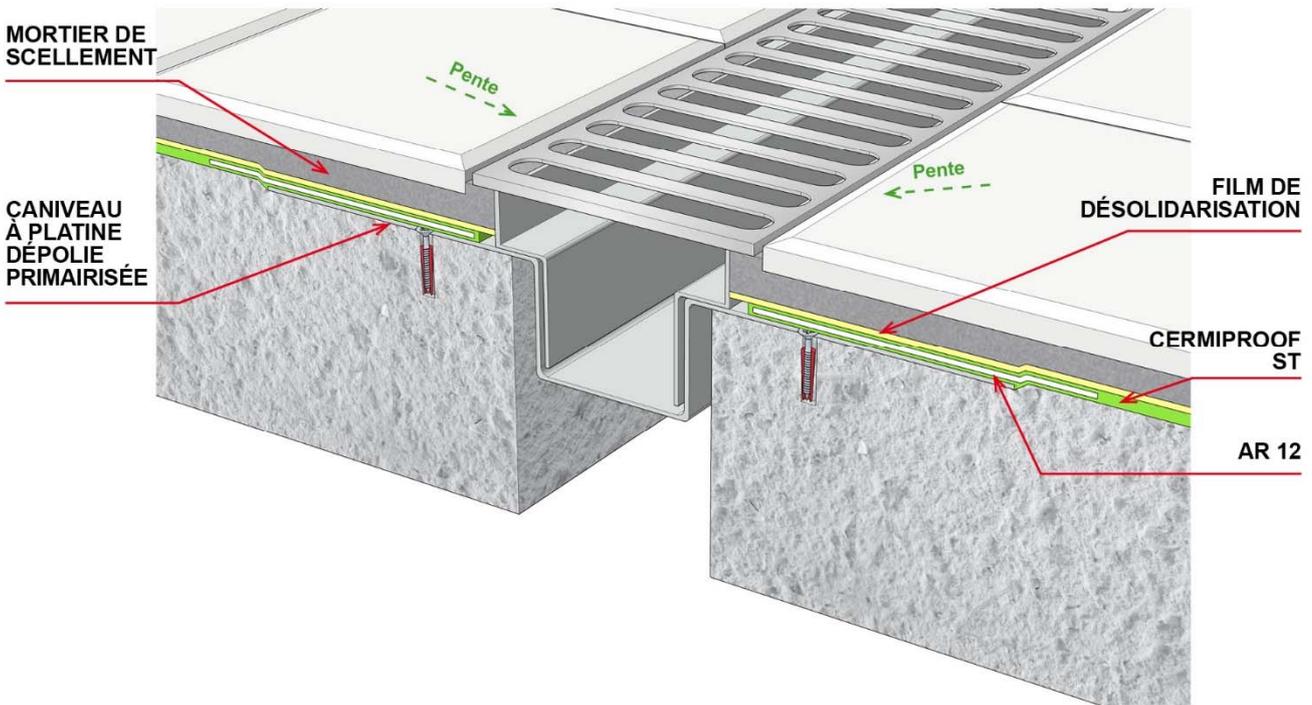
Raccordement à un dispositif d'évacuation des eaux : Caniveau en pose scellée
